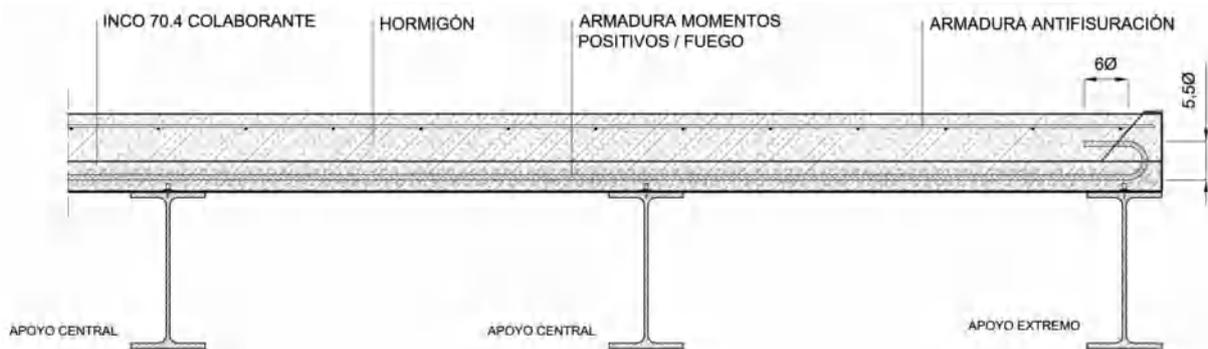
"Disposición de las armaduras de positivos/fuego sobre apoyos intermedios y extremo"
